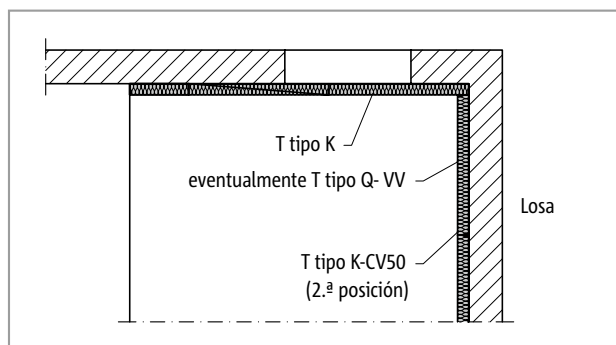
Schöck Isokorb® T tipo K, Q- VV: Balcón en esquina interna, apoyado sobre dos laterales
